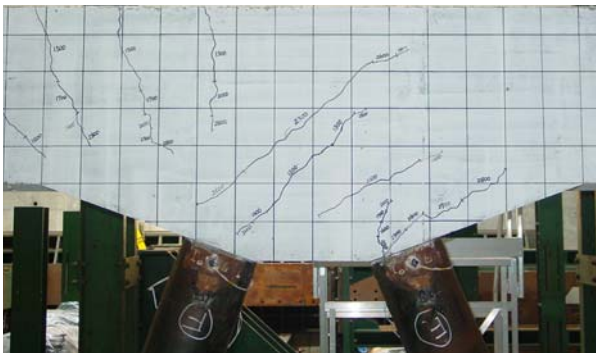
ひび割れ状況 (type1-2, 荷重 P=2,800kN)
